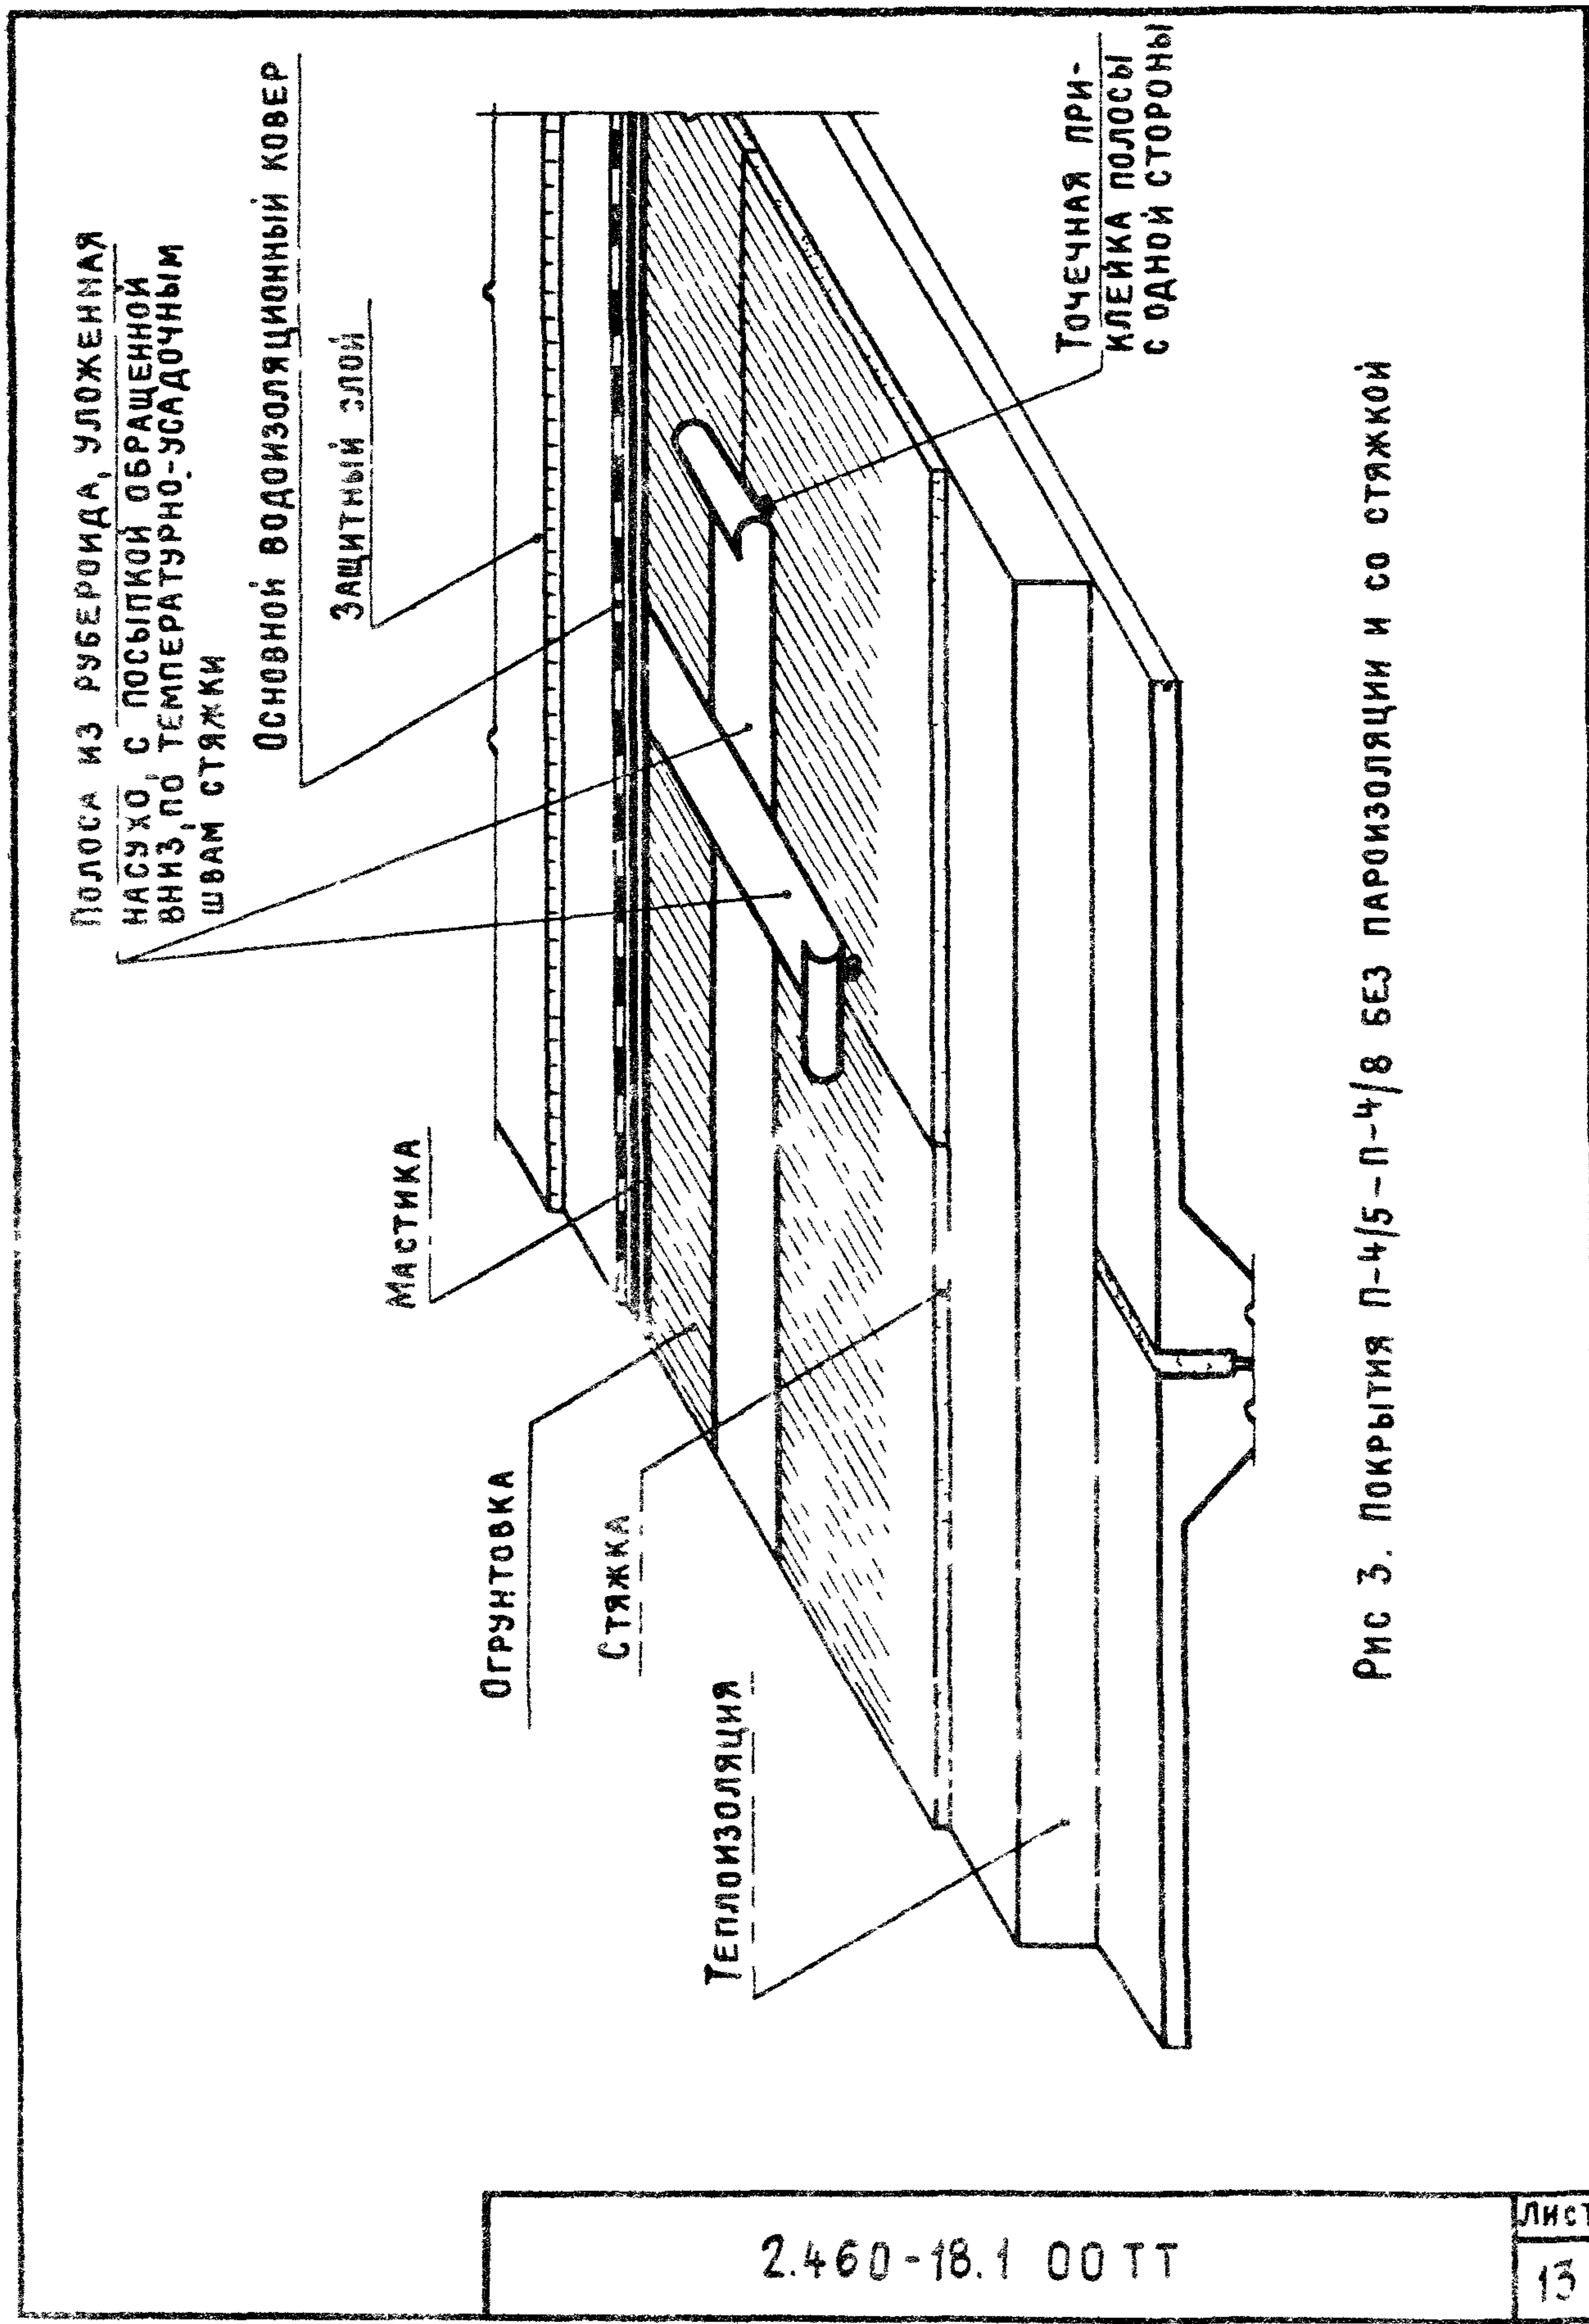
Покрытие П-4/5 - П-4/8 без пароизоляции и со стяжкой
